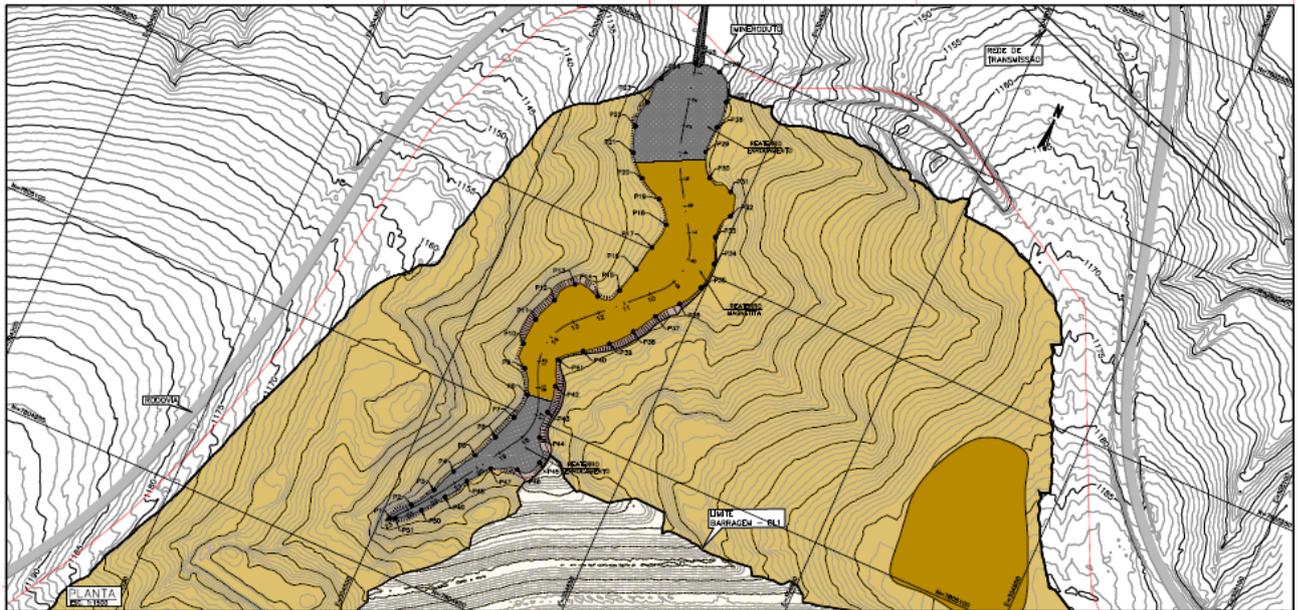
Arranjo geral do reaterro da fundação da PDR-1
